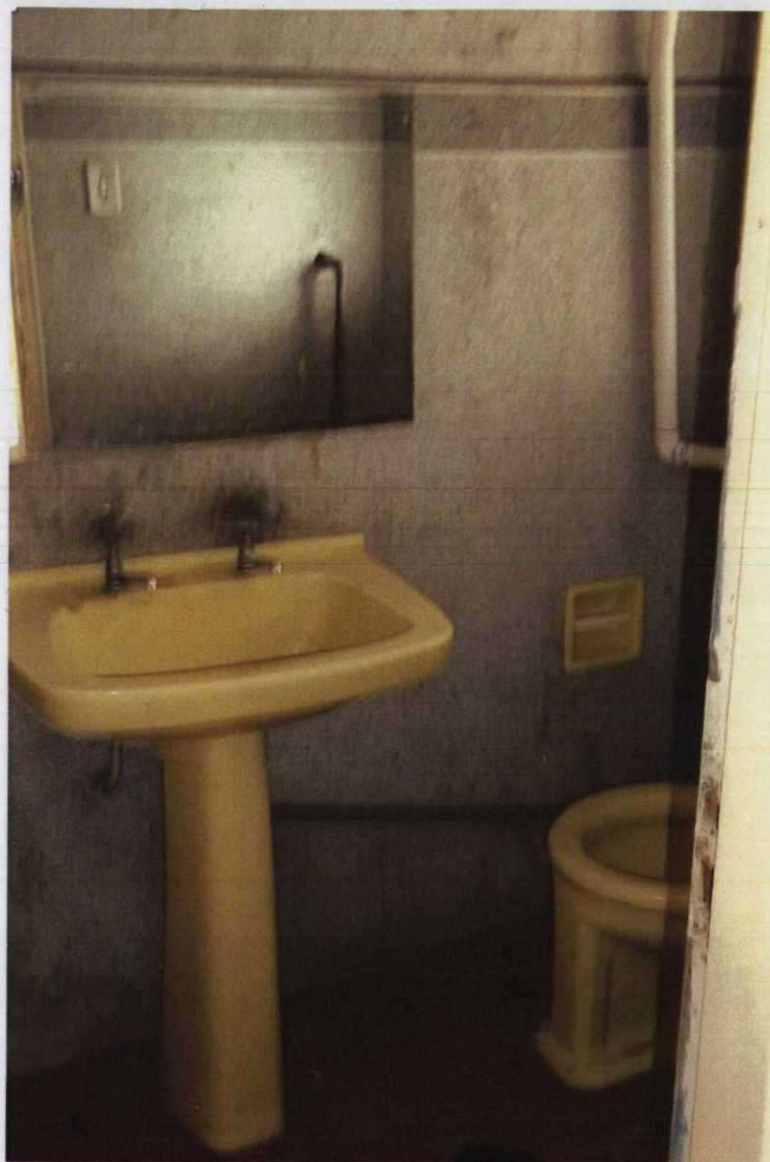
INTERIOR DO BANHEIRO PRIVE´ DO HALL
